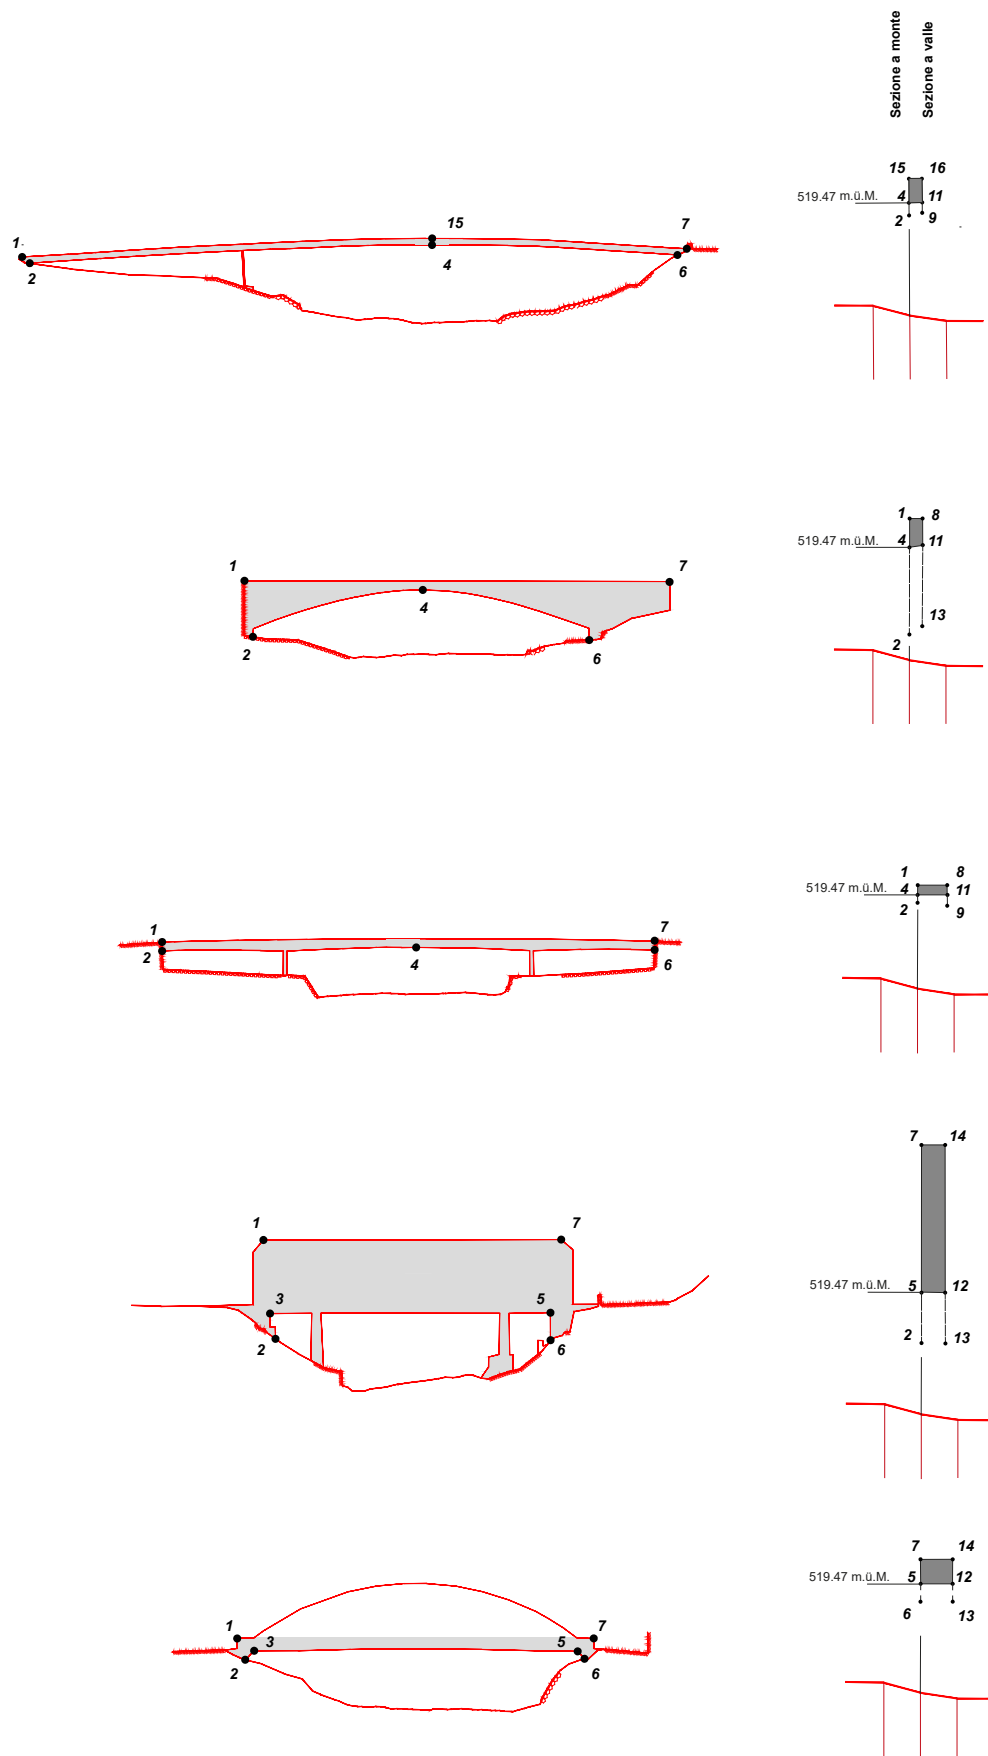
Esempi di rappresentazione di ponti nel profilo trasversale (a sin.) e nel profilo longitudinale (a dest.).
